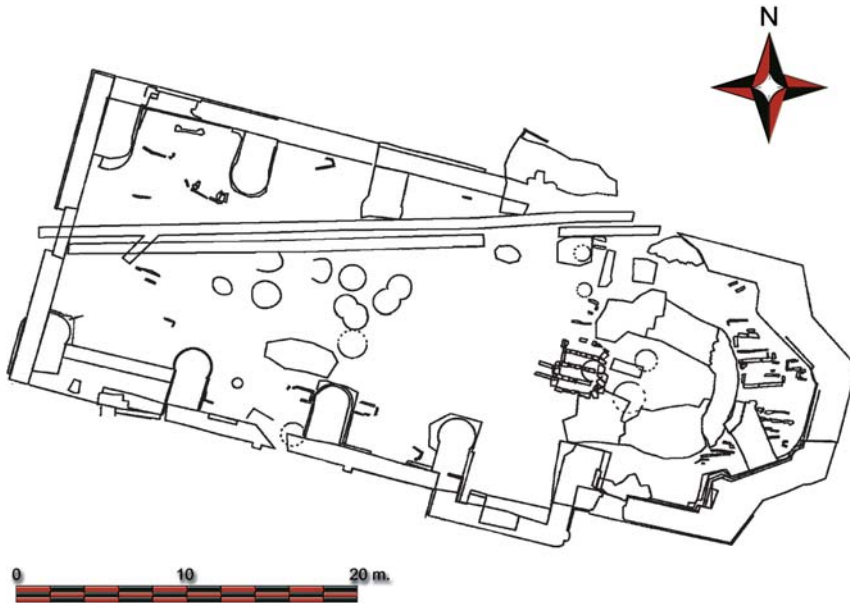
Planimetría de la planta de la iglesia de Valcuerna construida a inicios del siglo XVI. Restos actuales.
